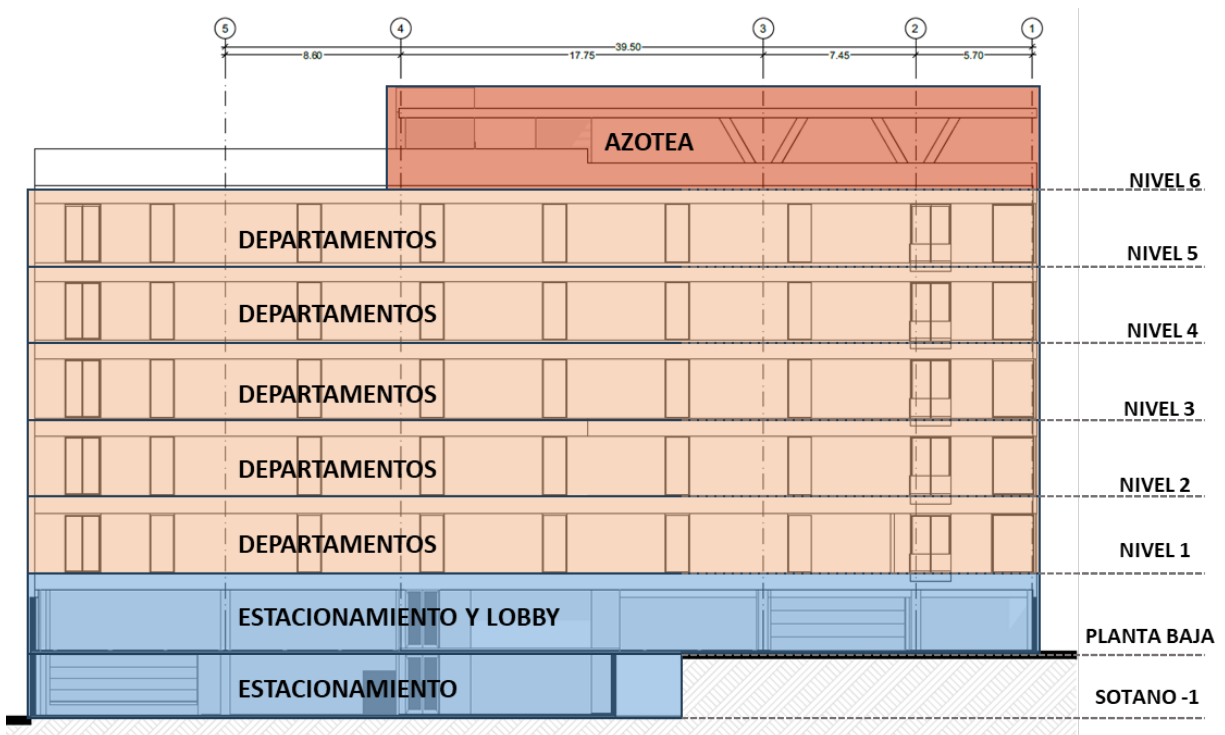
Niveles de anteproyecto. Fuente: Elaboración propia con alzado de anteproyecto.
